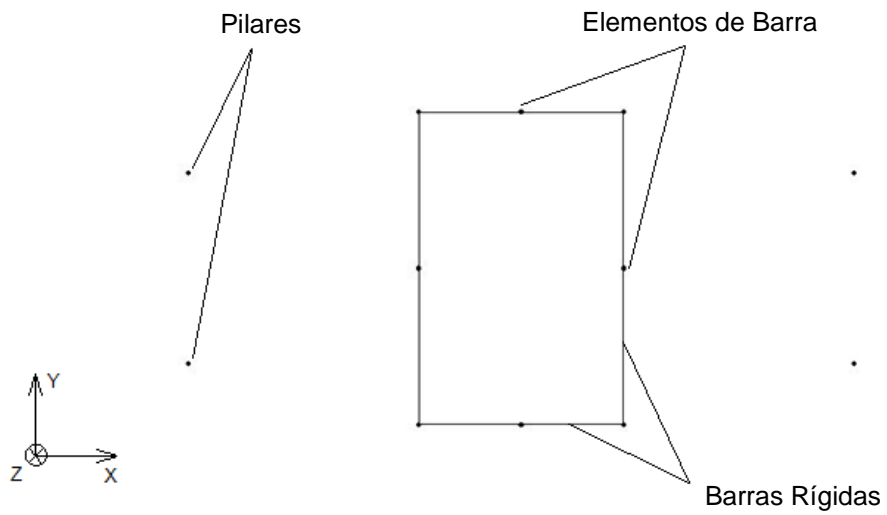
Vista em planta, a partir do 37º piso, do núcleo central sem aberturas e dos pilares laterais
